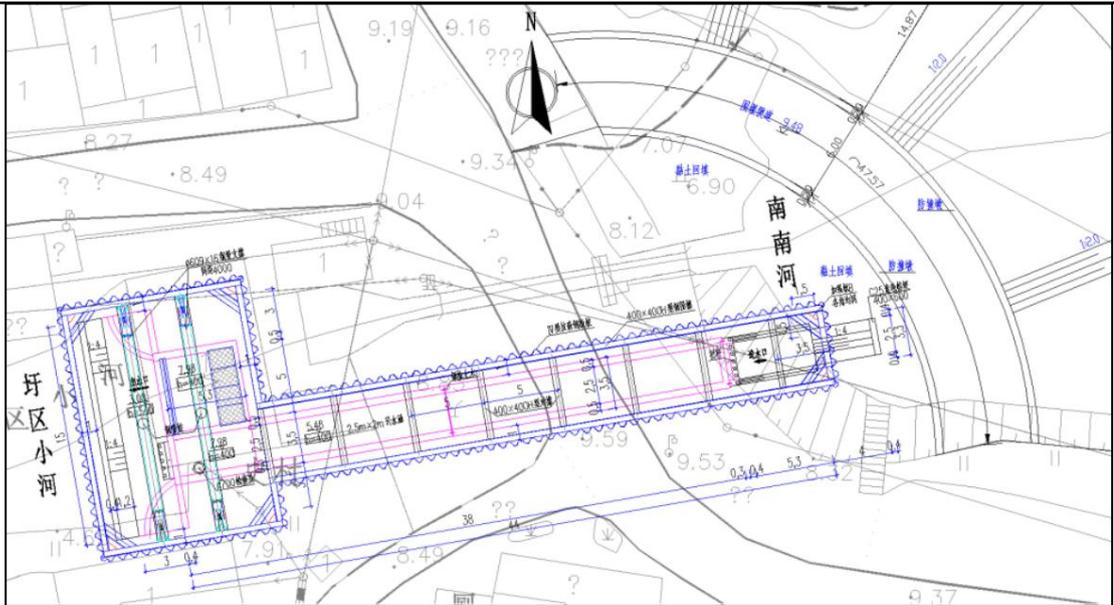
连通涵闸（原史村泵站位置）平面布置图
